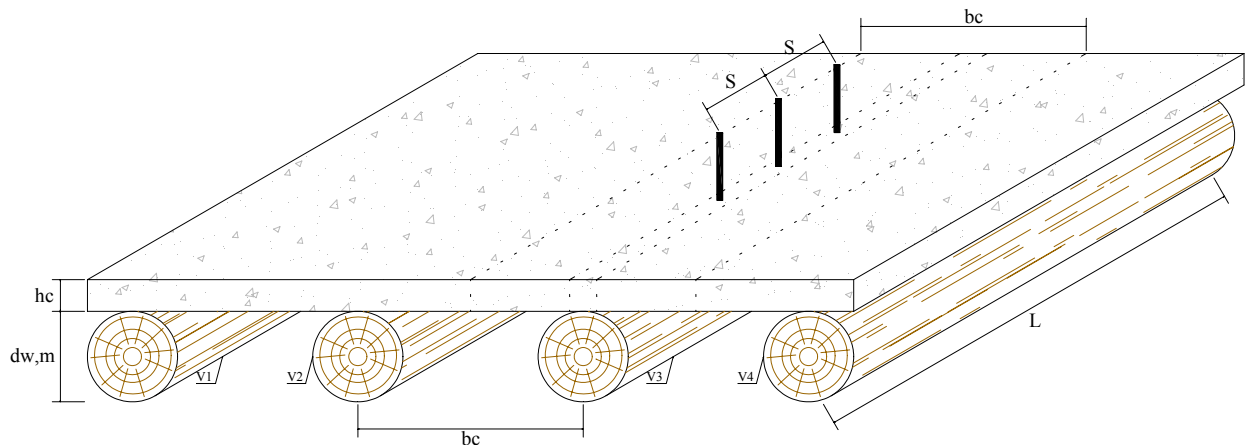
Projeto do modelo reduzido da ponte de madeira-concreto
